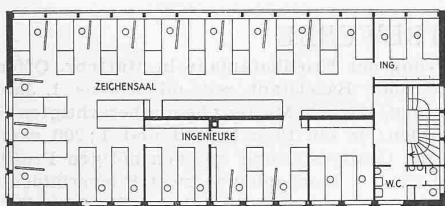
bis 7. Grundrisse und Schnitt 1:400
